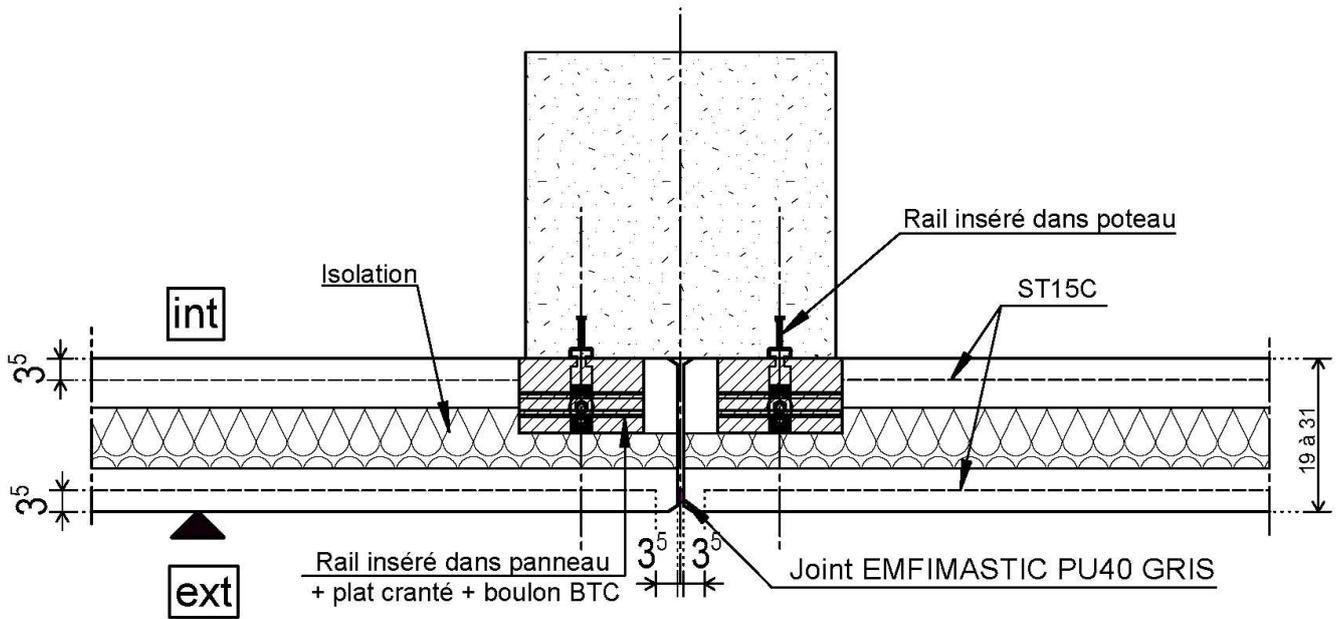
Panneaux sandwiches- Exemple de fixation sur poteau métallique en zone sismique - coupe horizontale
